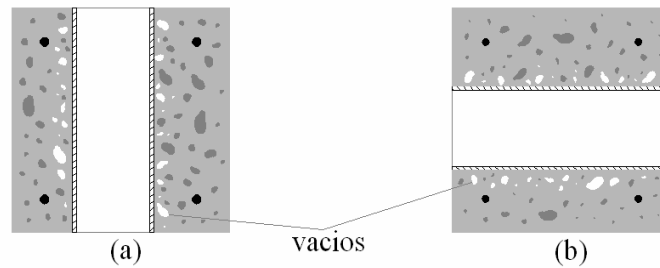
Vacíos en el concreto (a) producto de atravesar transversalmente una tubería vertical en una viga y (b) producto de atravesar transversalmente una tubería horizontal en una viga.
